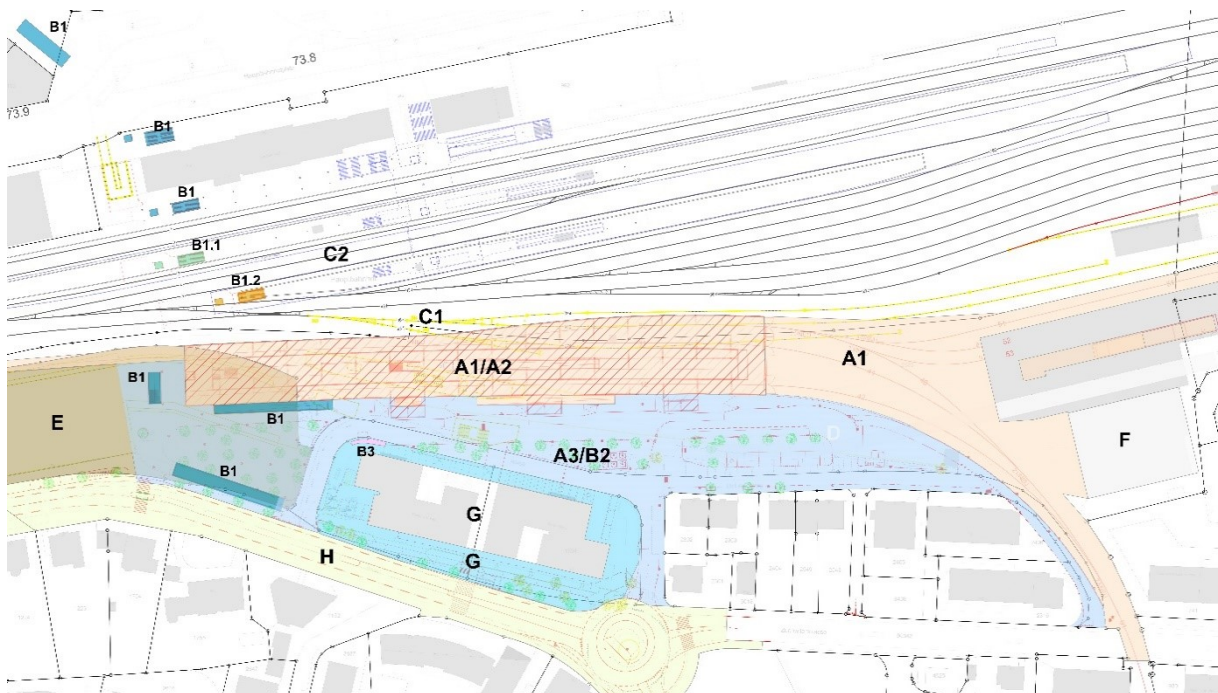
; Planausschnitt Situation auf Ebene Erdgeschoss mit Darstellung der Module
